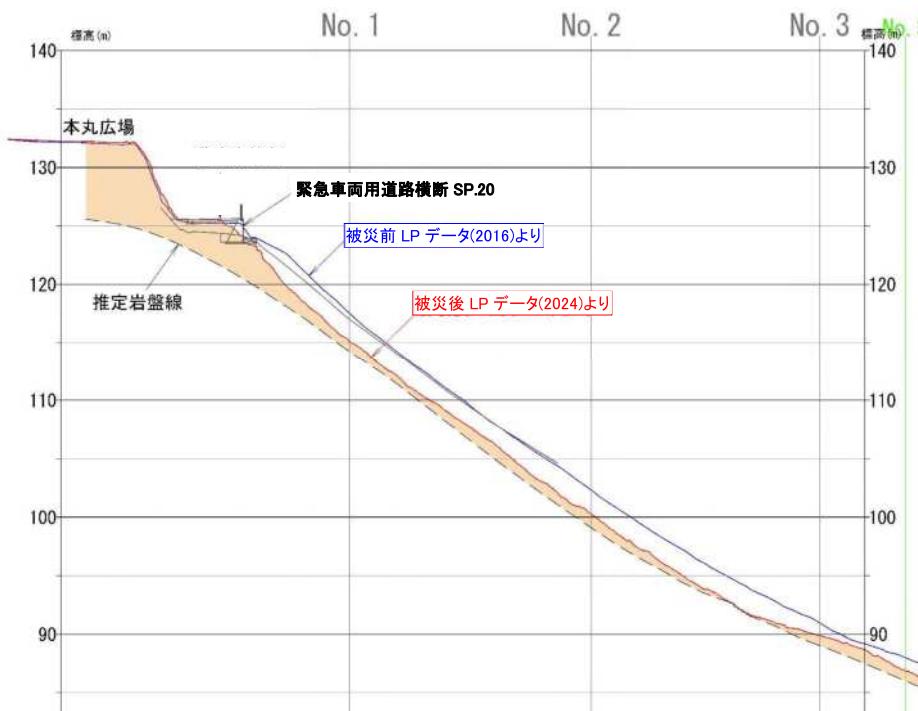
地質断面図 A-A' 断面（上流部上部付近）
